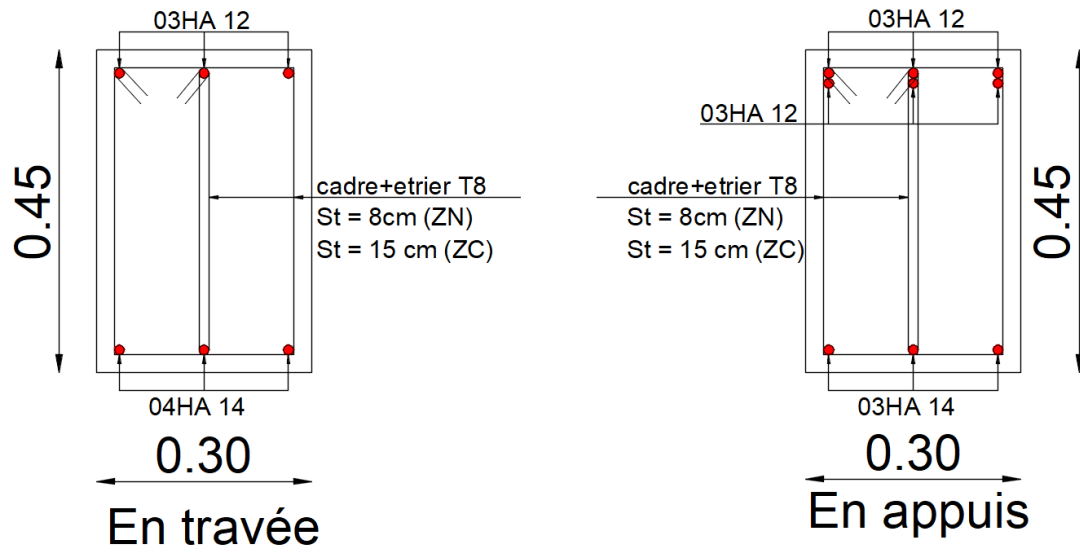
Schéma de ferrailage de la poutre principale 2<sup>ème</sup> étage au 11<sup>ème</sup> étage (30 x 45 cm<sup>2</sup>)
